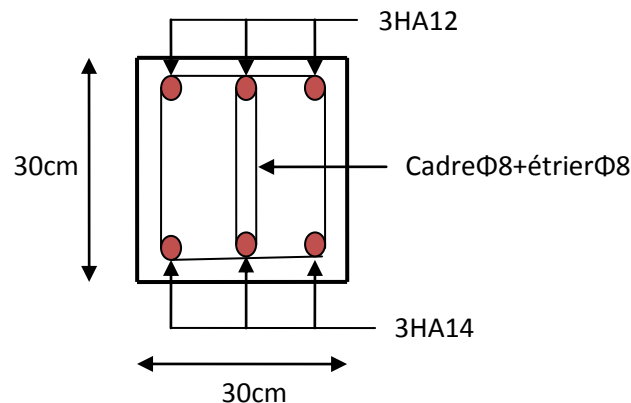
Schéma de ferrailage de la poutre brisée.
